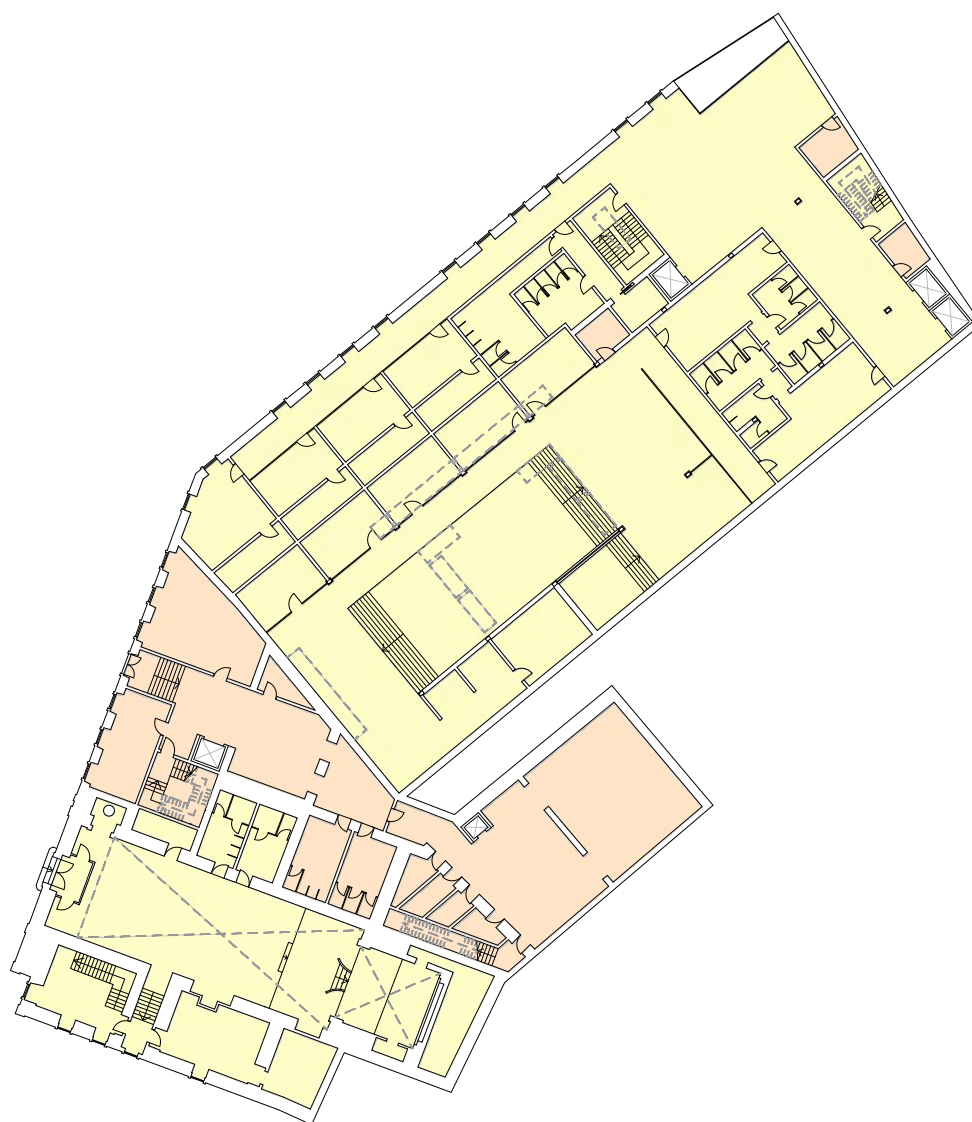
Planta original do piso - 1, à escala 1:500, orientada a Norte
